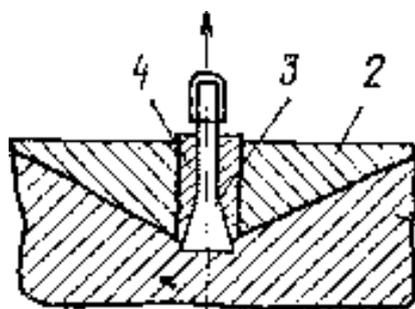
Испытания бетона на отрыв со скалыванием (вариант с разжимным конусом)
